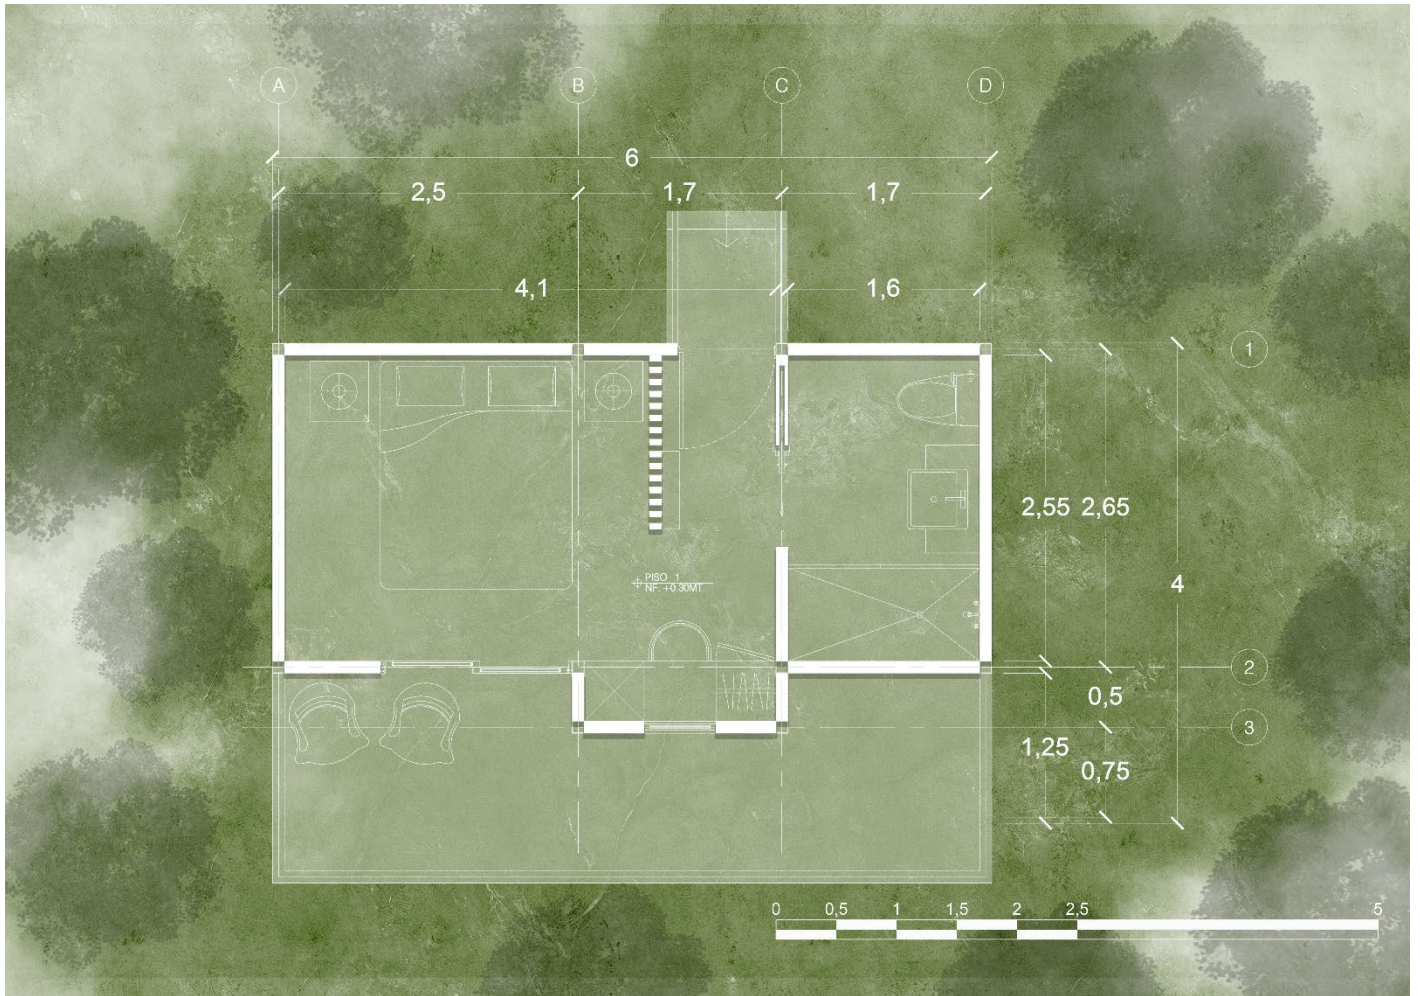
Planta arquitectónica de los módulos habitacionales
